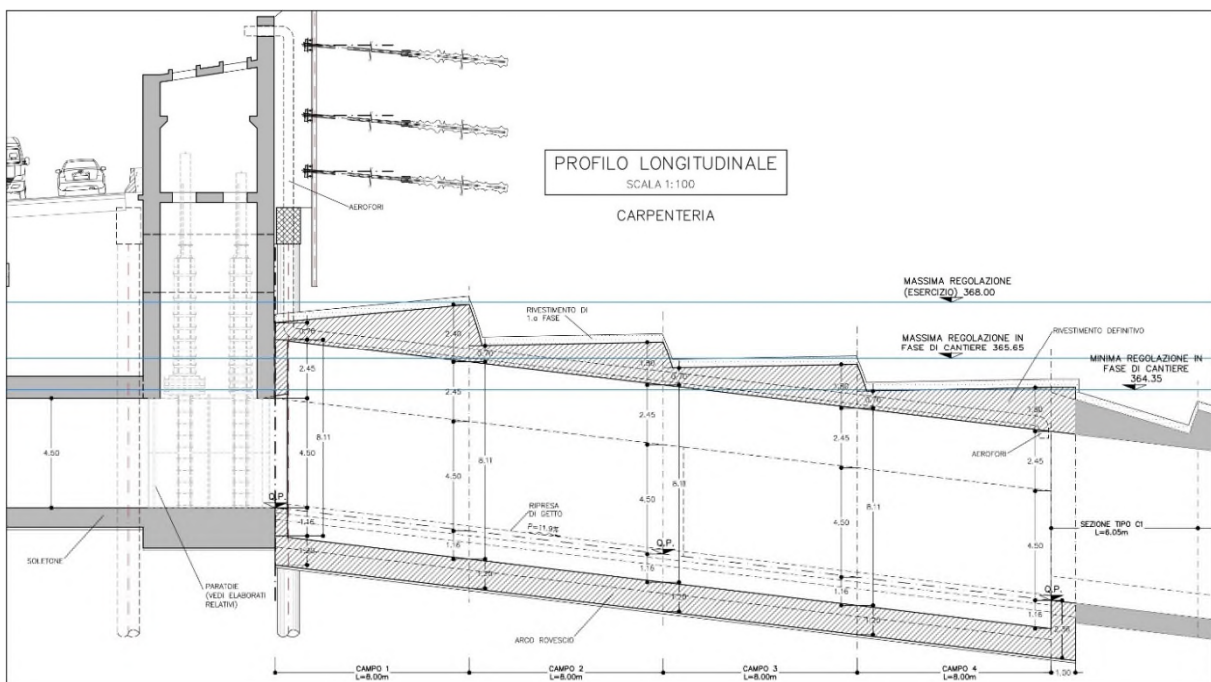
Sezione Camerone Convergente (campo finale) – Carpenteria – Profilo longitudinale
